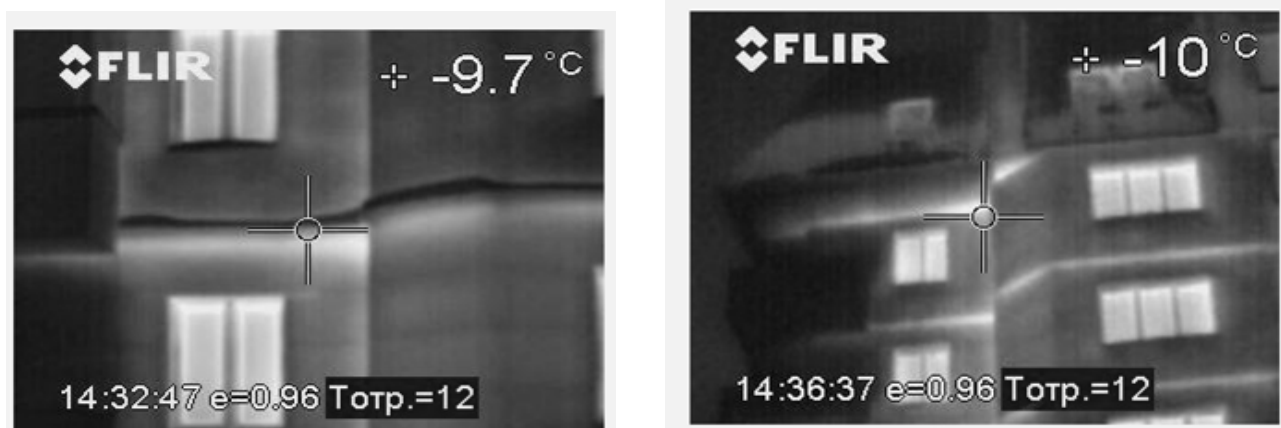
Теплотери через торцы плит перекрытий (монолитное перекрытие с применением температурных вкладышей).
